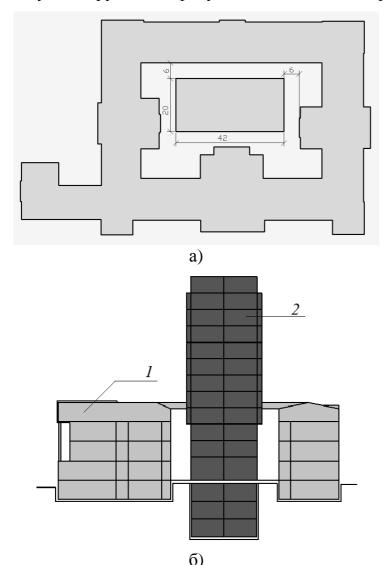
Проект реконструкции главного корпуса Национального горного университета: а — план зданий, б — схема расположения и конструкция старого (1) и нового (2) зданий.
